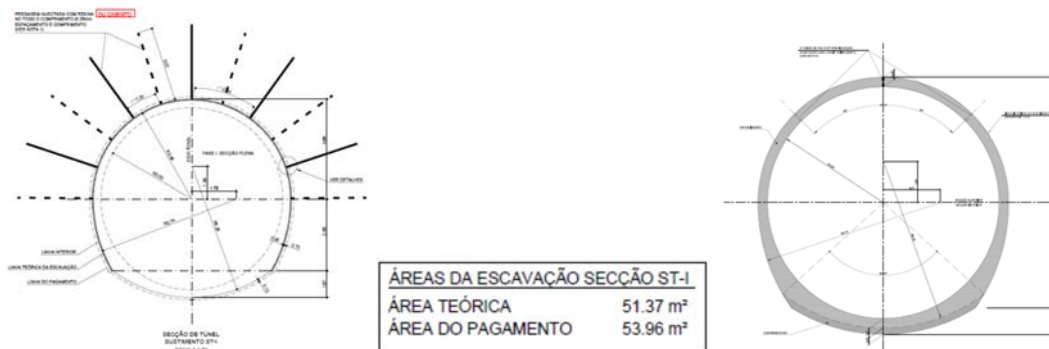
Secção tipo e volumes teóricos e de pagamento da escavação e betão
